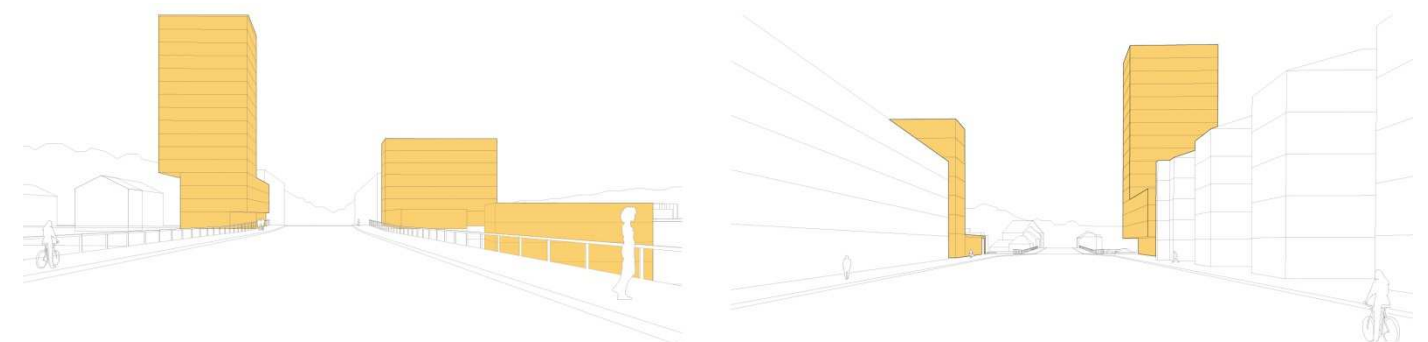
Illustration zur denkbaren Nutzungsverdichtung am Brückenkopf (Quelle: Schlussabgabe Team Bauart)
